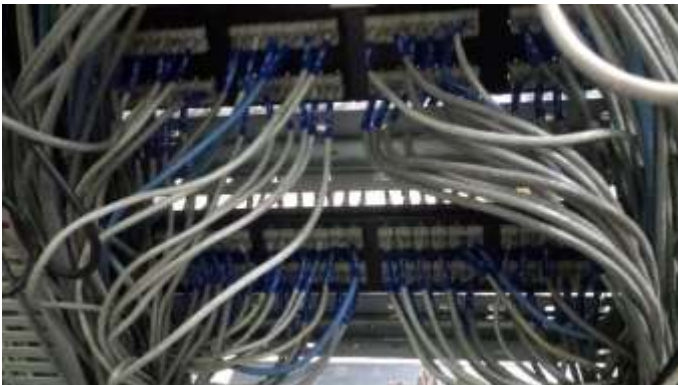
Etiquetado Cableado Horizontal Rack 2 (1)
